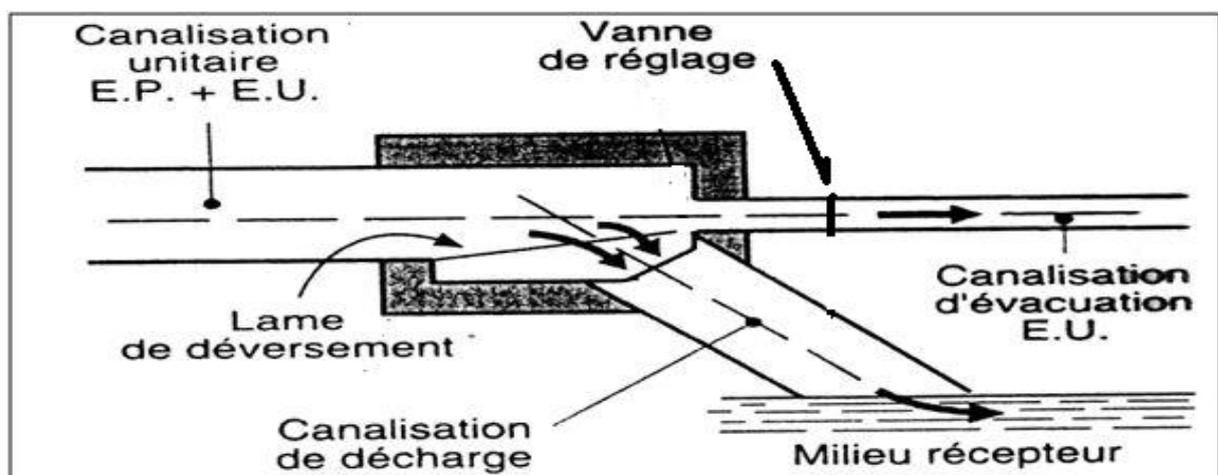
schéma d'un déversoir d'orage type latéral.
